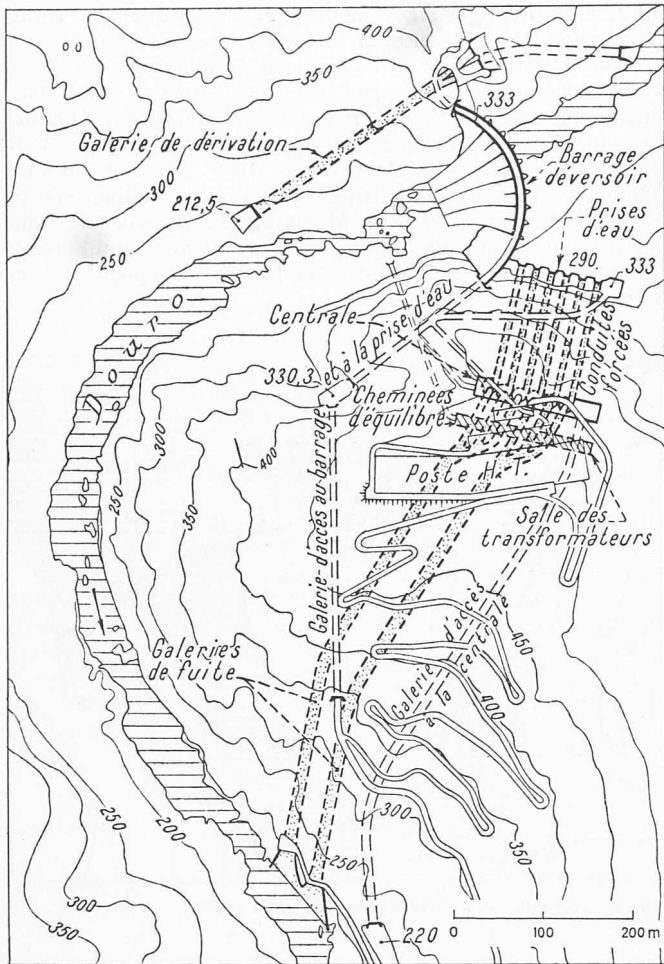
Lageplan des Kraftwerks Aldeadavila 1:8500
